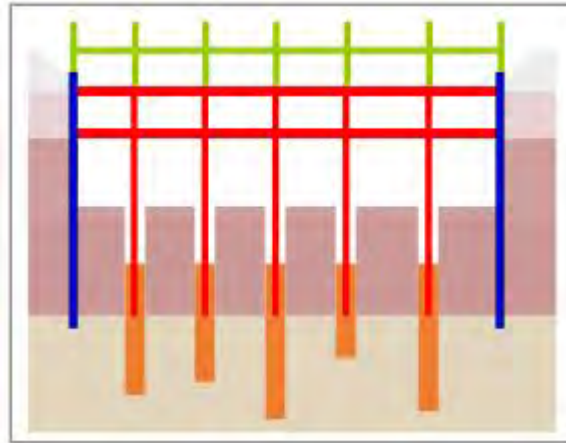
Excavación de los sótanos inferiores y comienzo de la construcción de la superestructura– Down tradicional. Fuente: Pilotes Terratest Perú S.A.C, 2021
